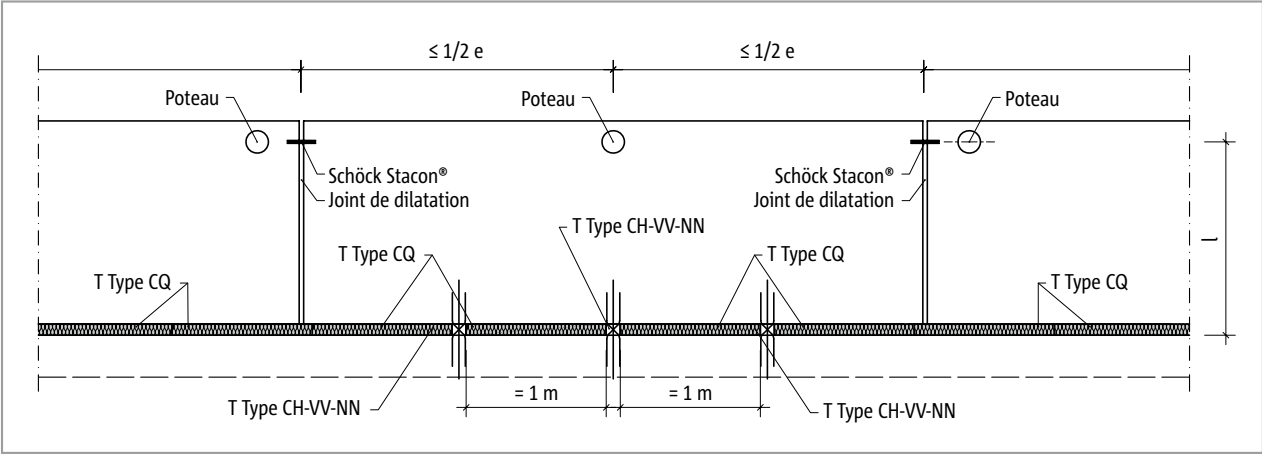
Schöck Isokorb® T Type CH : disposition du joint de dilatation
